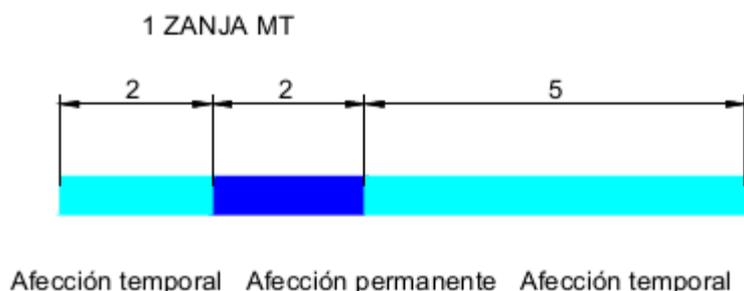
Esquema en sección del ámbito del PEI en las líneas subterráneas de conexión.
